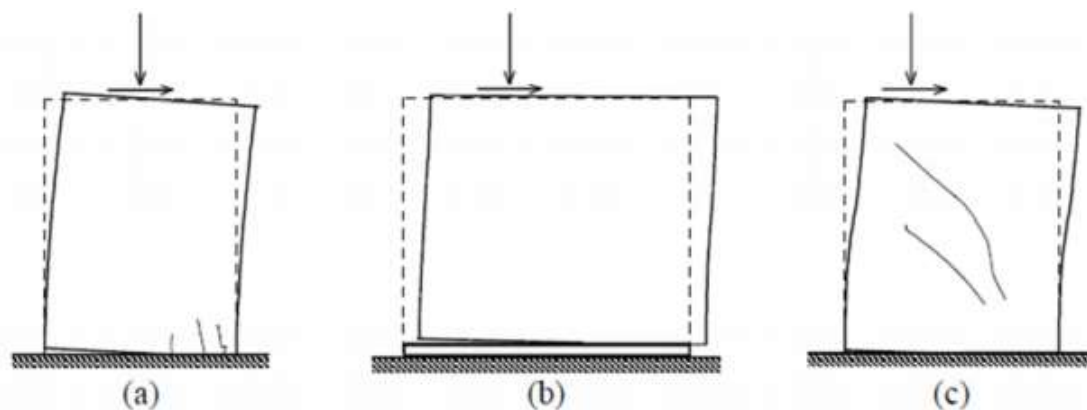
Mecanismo de rotura no plano das paredes de alvenaria (Silva, 2016)
